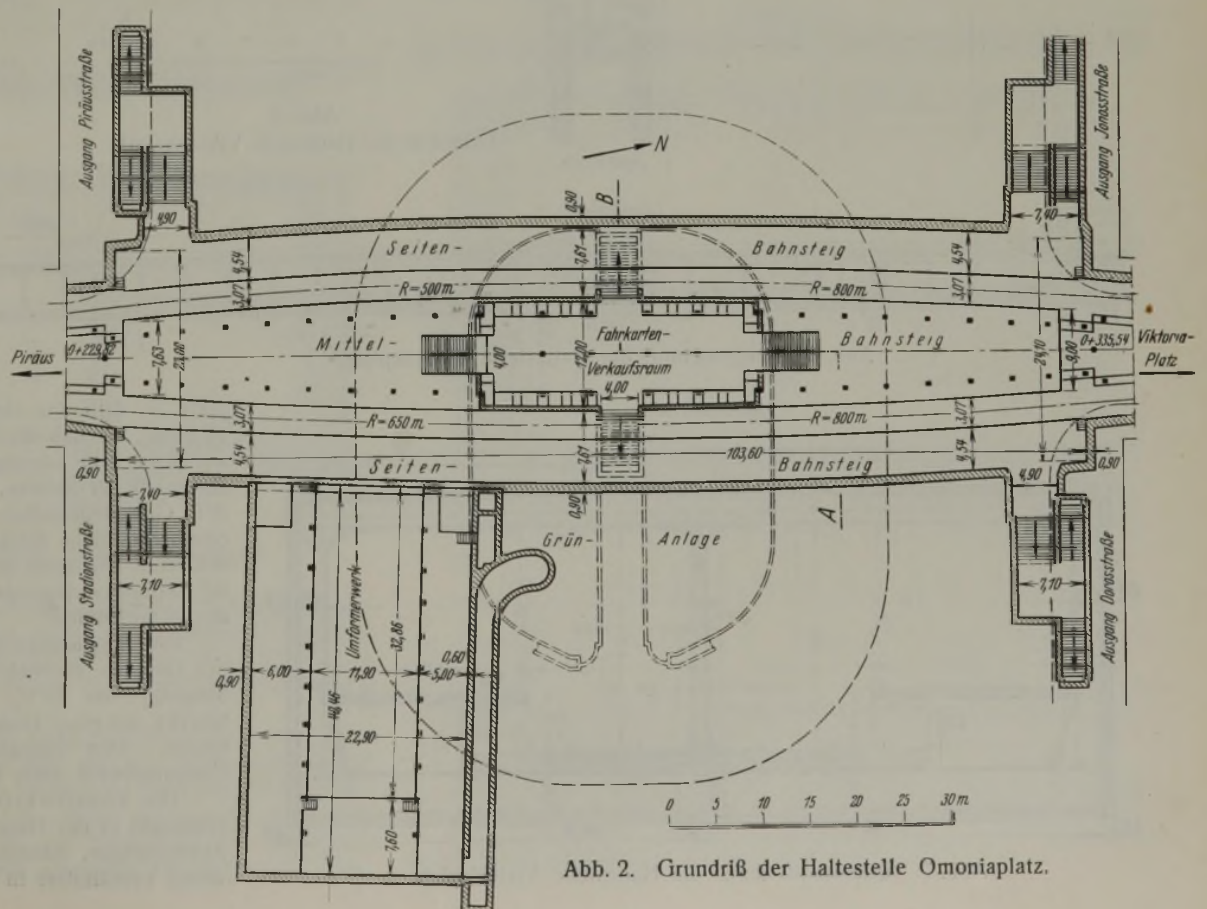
Grundriß der Haltestelle Omoniaplatz.
